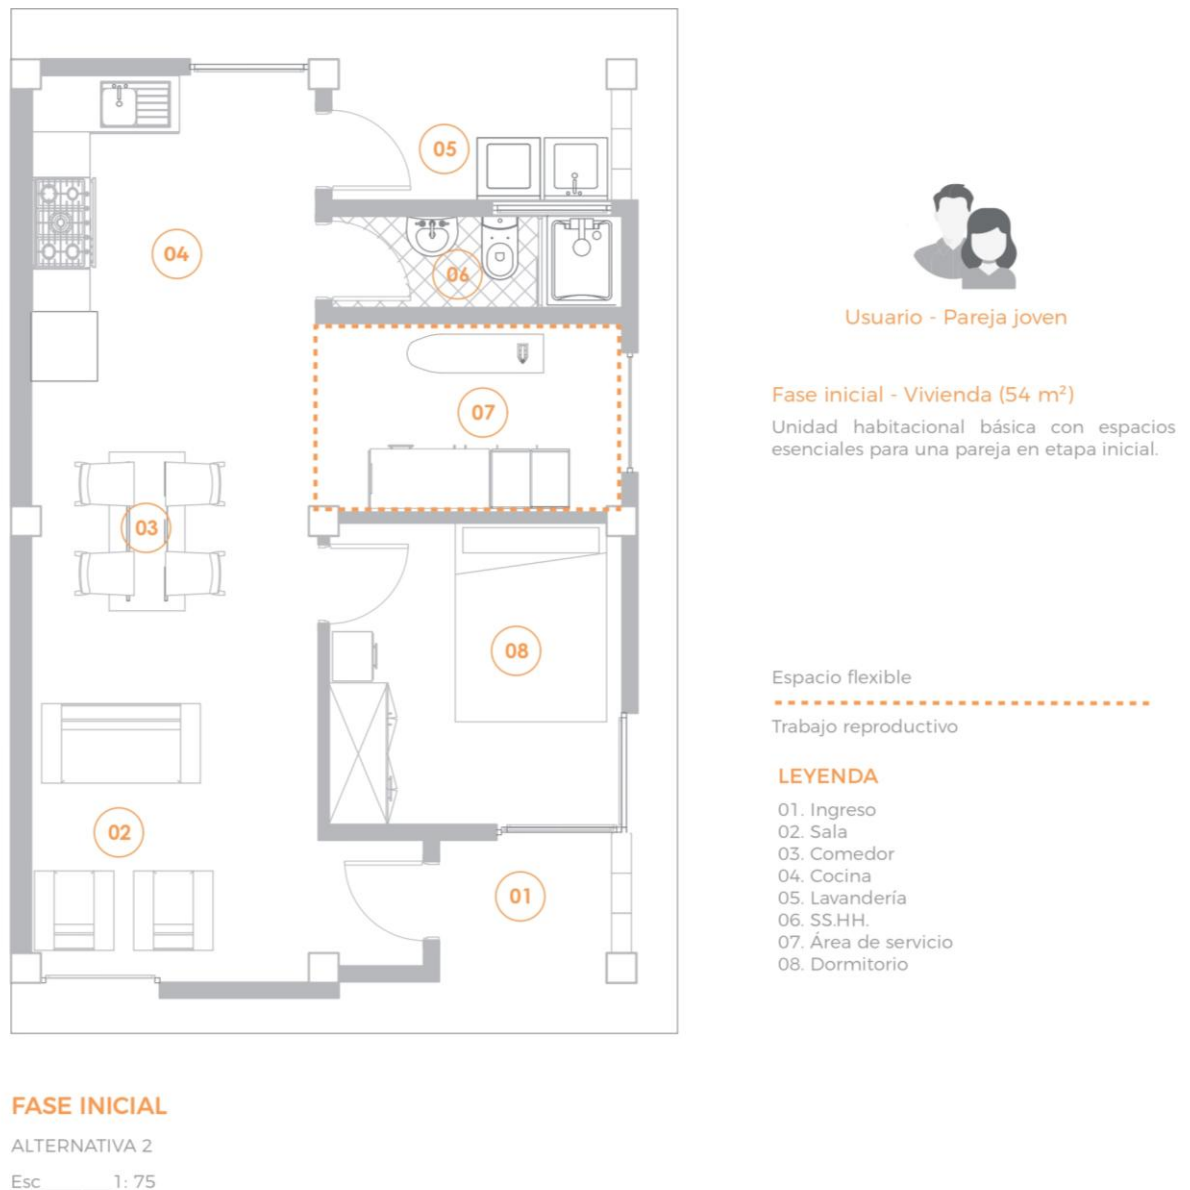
Planta arquitectónica – Alternativa 2 *Nota.* Elaboración propia
